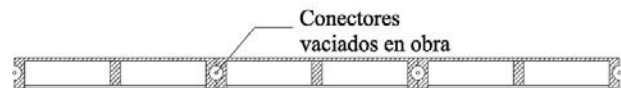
Conexión entre placas de paredes continuas primera alternativa.
